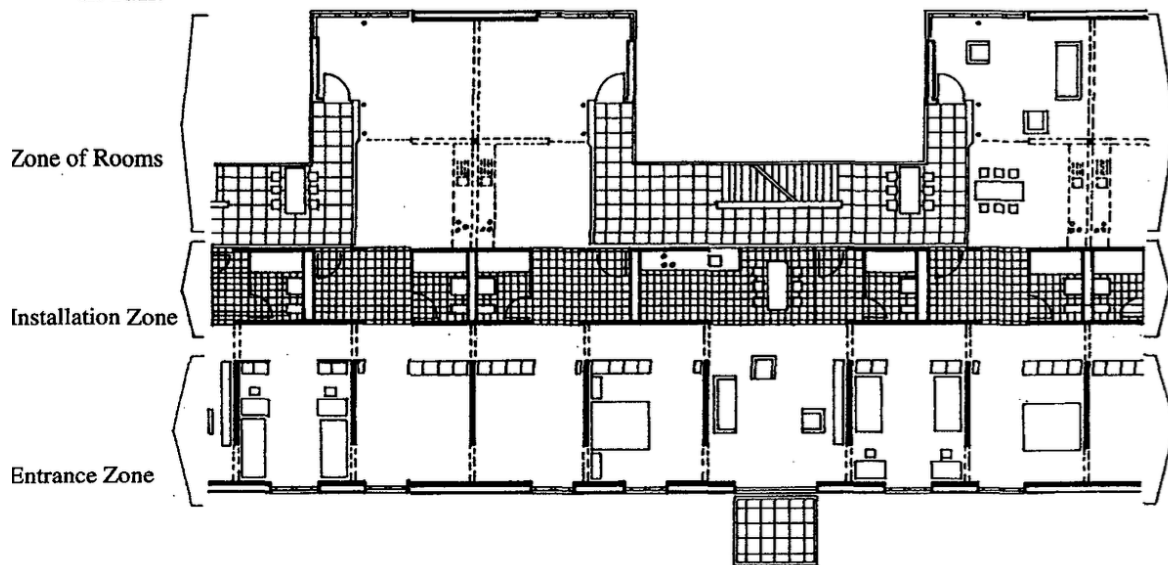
Hellmutstrasse* (1990) - Planta de frações.
